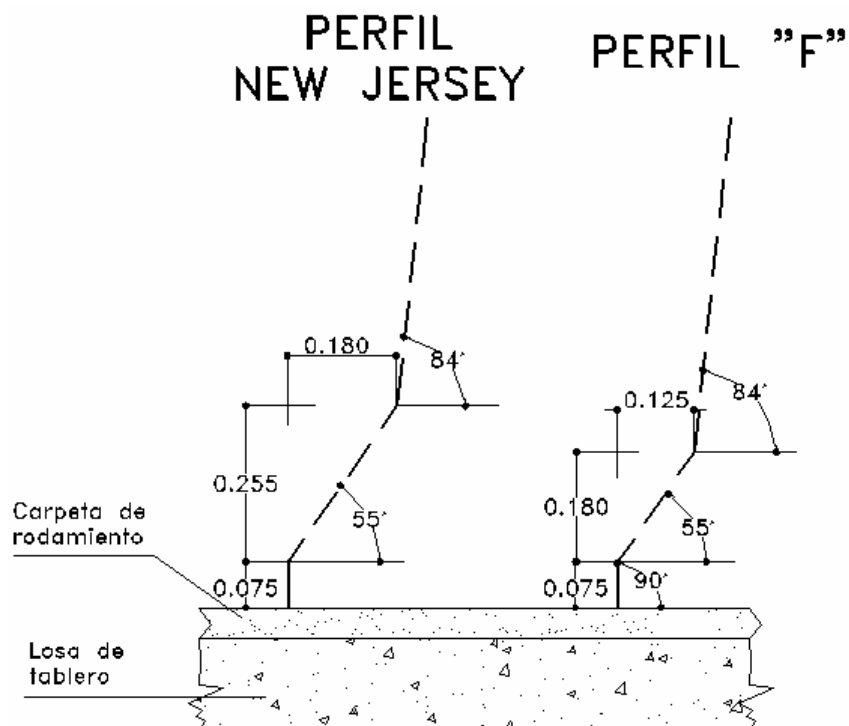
Perfiles típicos de las barandas de hormigón armado
